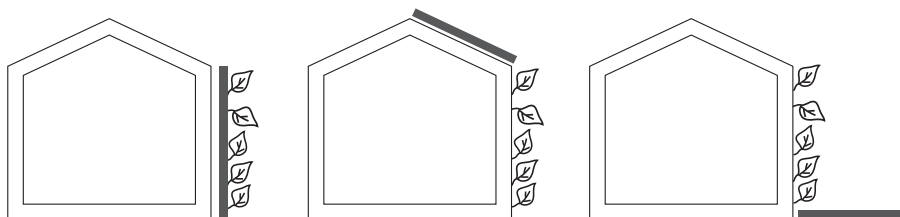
\_Collocazione del suolo rispetto alla parete verde: in facciata, in copertura, a terra.
